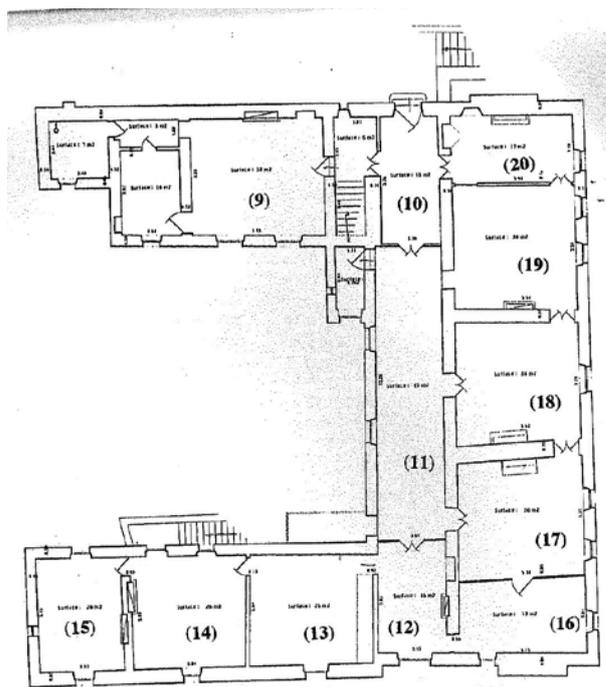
Citadelle de Blaye - Pavillon de la Place – plan du rez-de-chaussée. Coll. privée.
